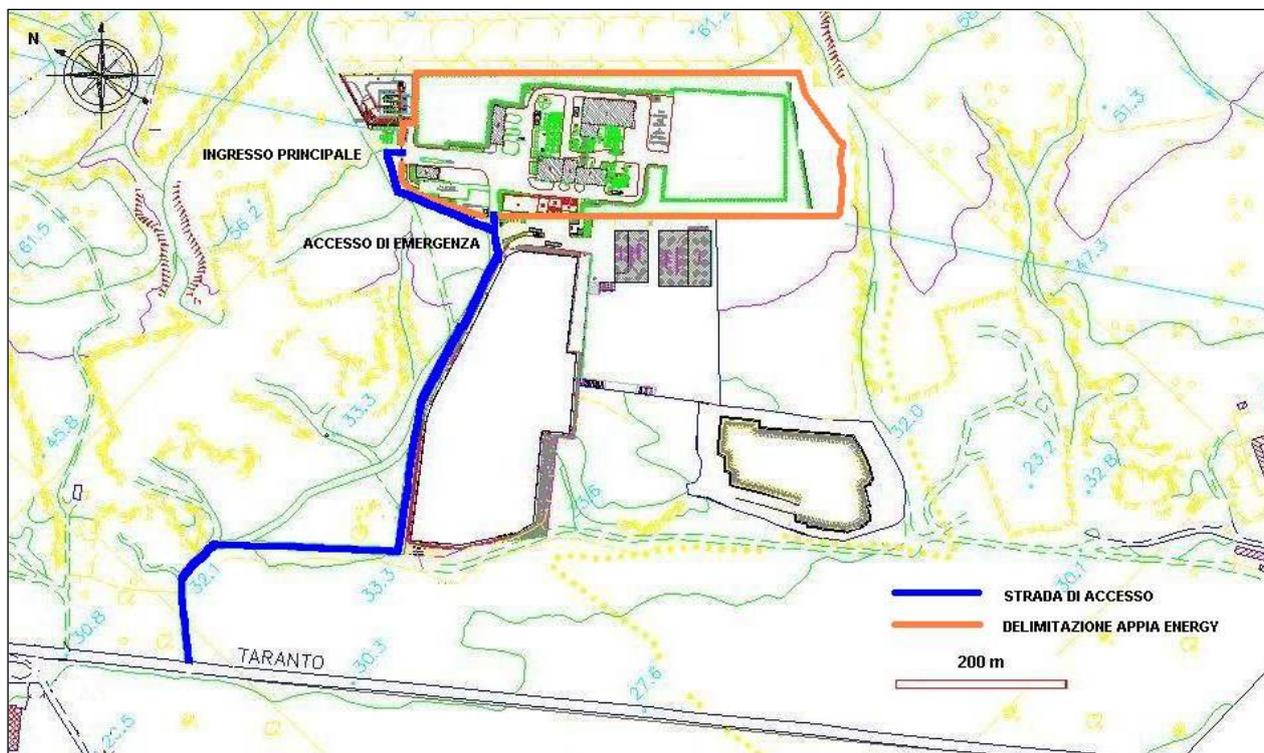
c: Planimetria generale con viabilità esterna
